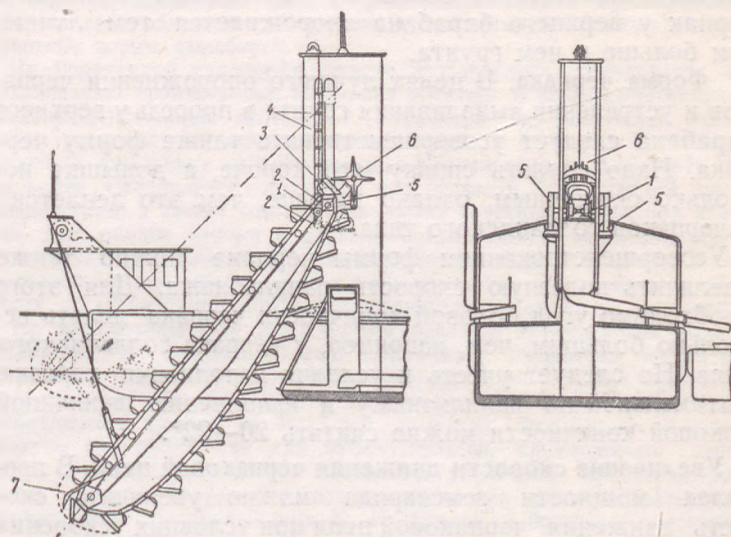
Землечерпательный снаряд с параллельно перемещающейся черпаковой рамой, черпаковой крышкой у нижнего барабана и черпаковым брандспойтом у верхнего барабана
